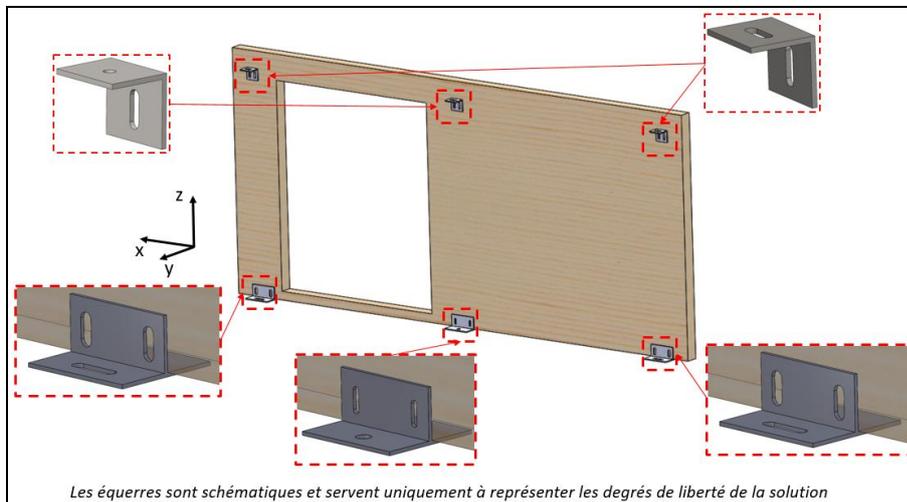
Façade Filante posée avec appuis multiples en bandes horizontales
